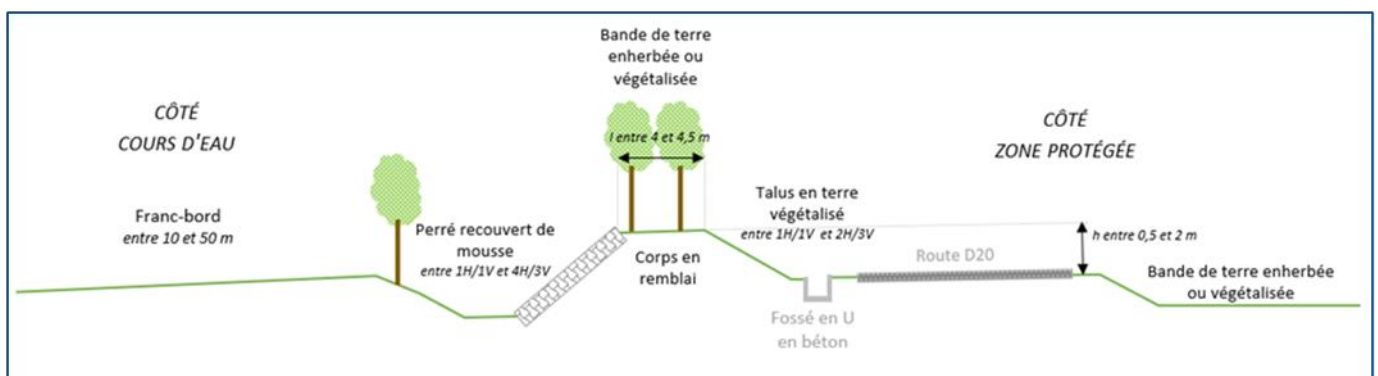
Coupe type du système d'endiguement de Lamothe – Tronçon 1 / Section a (T1a)
